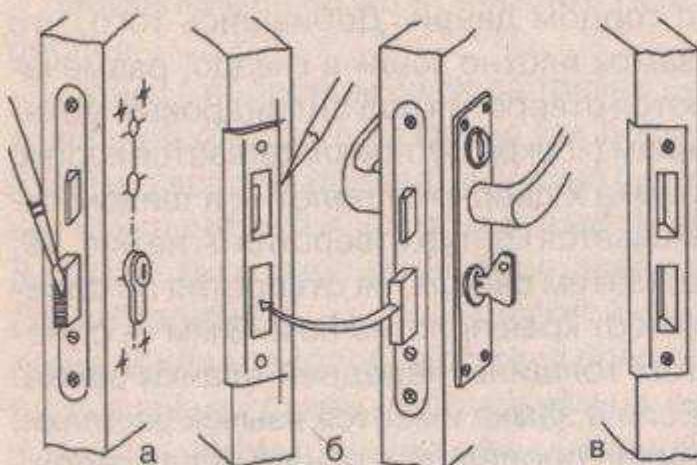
Врезка нового замка (продолжение): а — нанесение краски на торцы защелки и ригеля; б — нанесение краски на дверную коробку; в — выбирание пазов и вставка запорной планки
